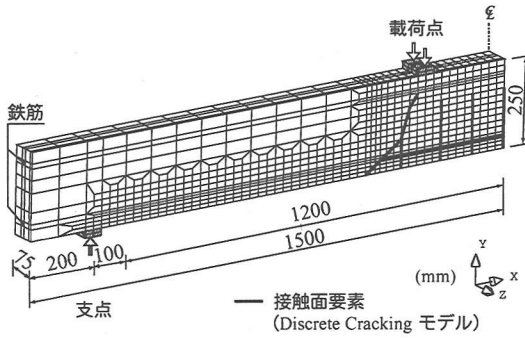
試験体の形状寸法、配筋状況、載荷点位置およびシートの接着概要図
